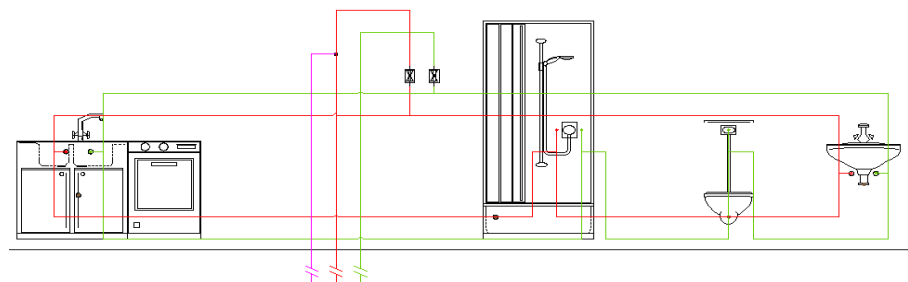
Beispiel einer Stockwerksinstallation mit Ringleitung
